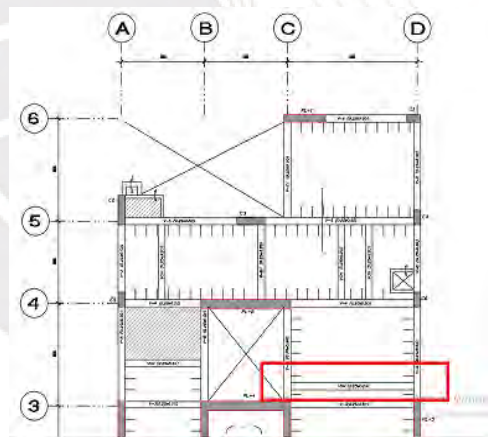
Acercamiento a los ejes 3-4 y C-D en el plano de estructuras
